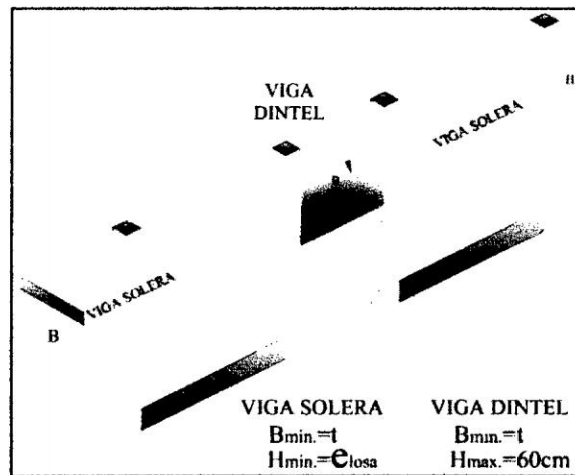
Elemento de confinamiento Horizontal (Vigas)
